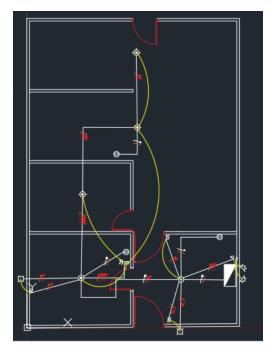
Plano de distribución del cableado eléctrico. (Autor)
